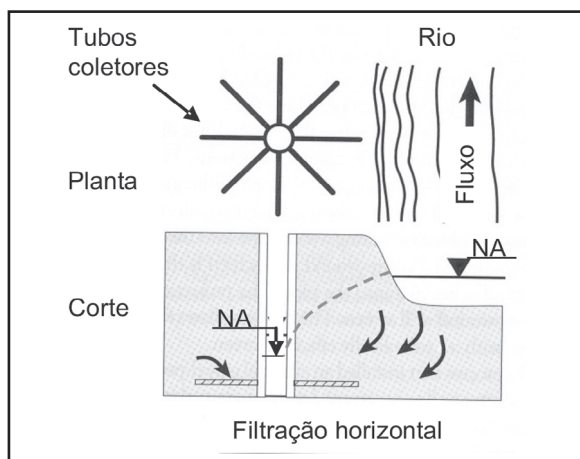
Planta e corte de um sistema alternativo de FMR: poço de coletores horizontais
